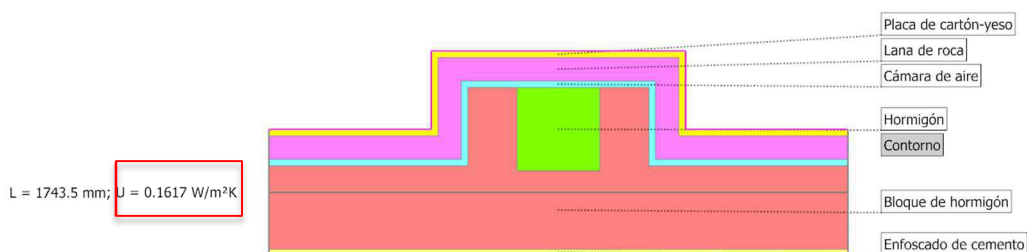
Detalle del puente térmico de pilar en fachada con indicación del cálculo obtenido con TERMUS-BRIDGE. Elaboración propia.
